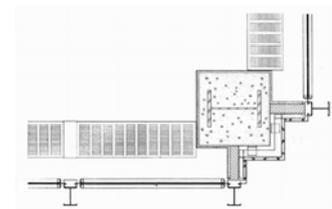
Eckverbindung des Seagram Building von Mies van der Rohe, hier spielt die Fassadenkonstruktion einen Stellvertreter für die dem Betrachter verborgenen einbetonierten Stützen
